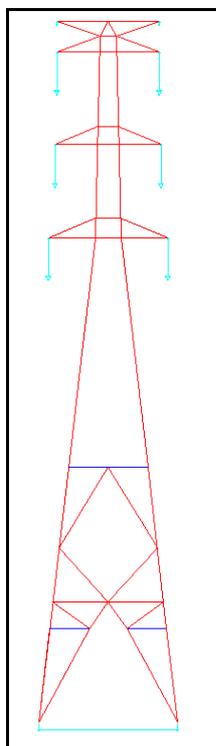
Silhuetas típicas das estruturas autoportantes que serão utilizadas na construção da LT 500 kV Manaus - Boa Vista e Subestações Associadas
